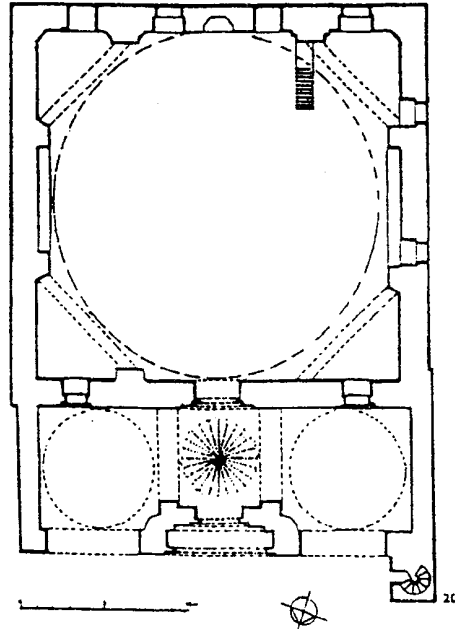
مسقط أفقى لجامع الخاتونية
